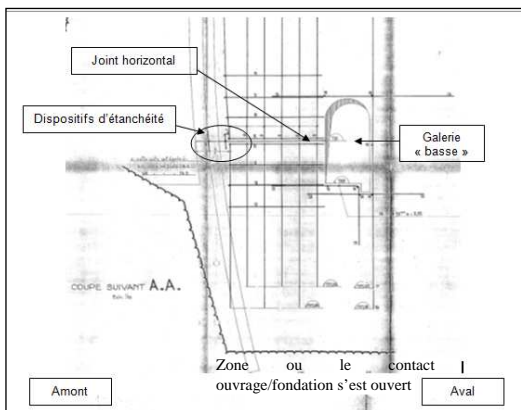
ferrailage du pied du barrage au voisinage de la galerie basse et articulation (joint horizontal).
